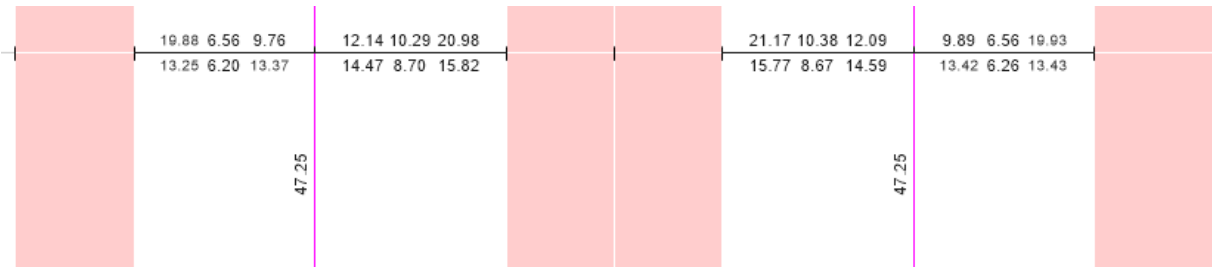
Acero Requerido por momentos en Vigas 5° Piso
